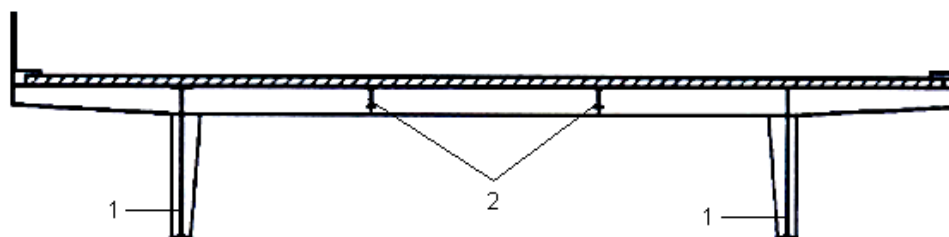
Корытообразная сталежелезобетонная конструкция пролетной части двухпутного железнодорожного моста пролетом 40 м с нижней сталежелезобетонной плитой и сталежелезобетонными балками [13]
